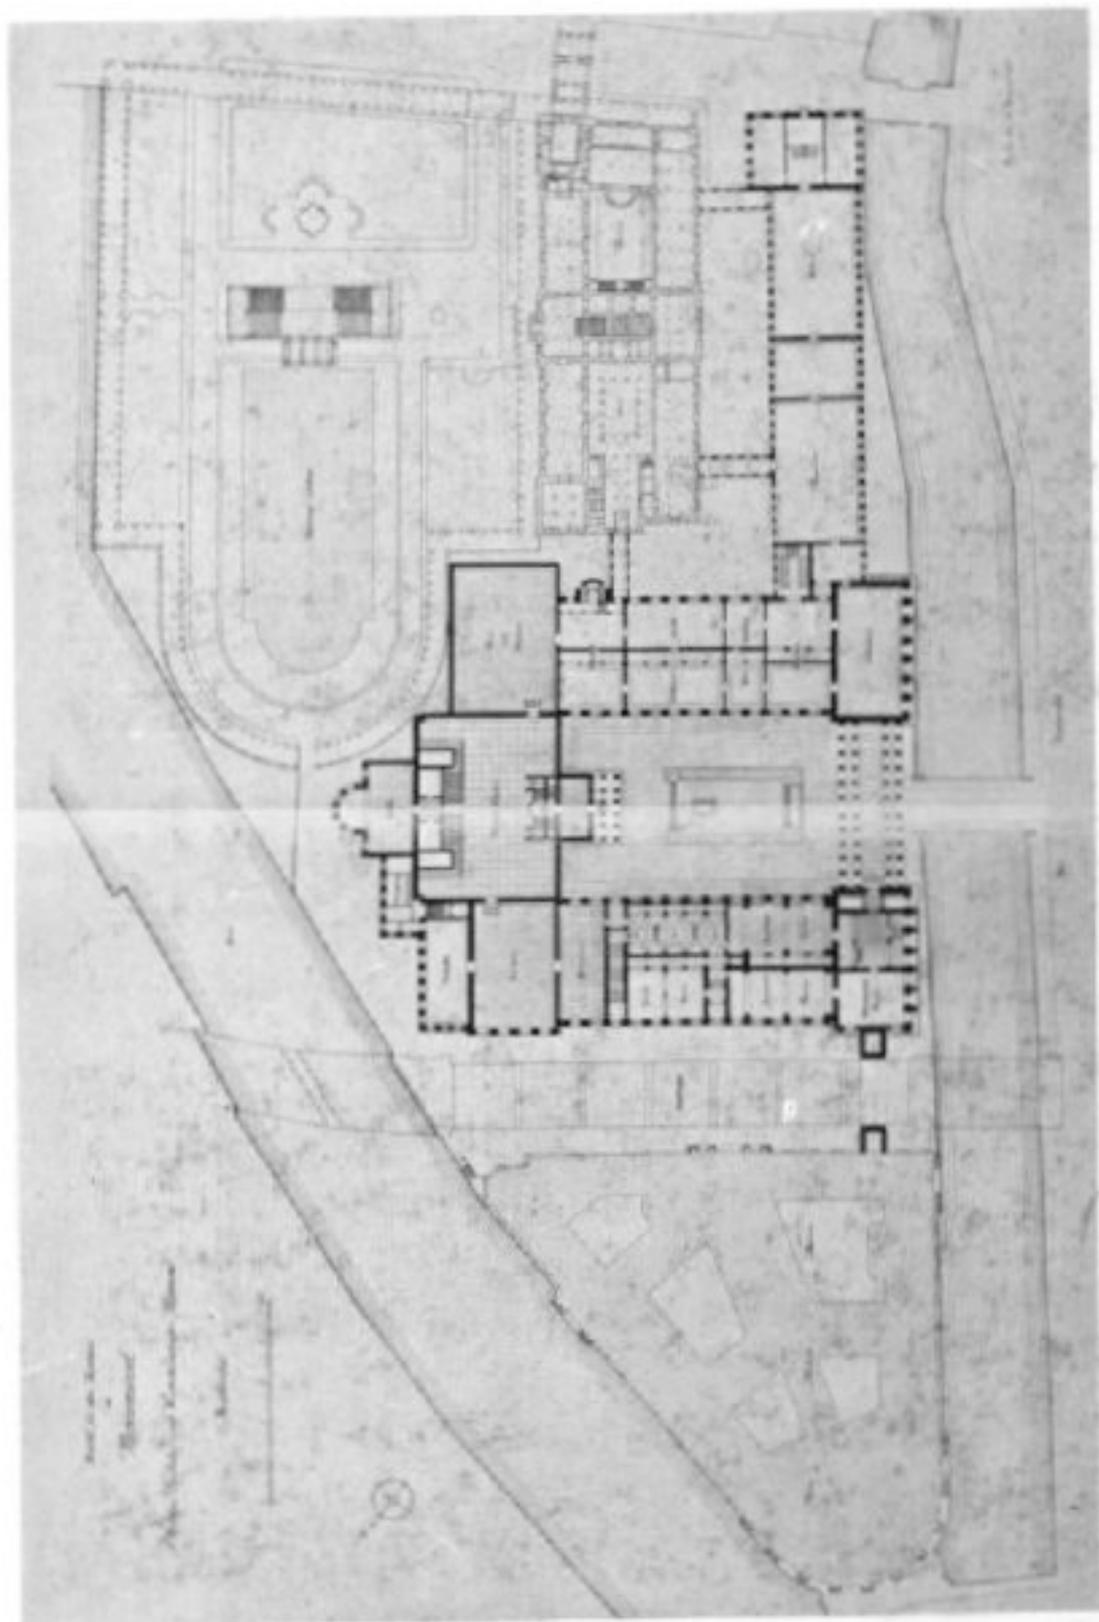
Plan du projet des nouvelles constructions de musée, 1907
